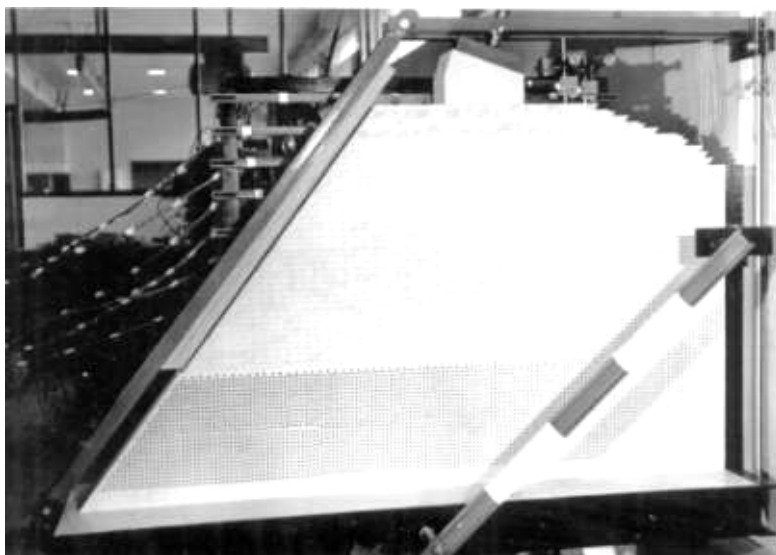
Modelo plano da fundação da barragem de Cambambe, com um sistema de juntas contínuo e outro descontínuo
